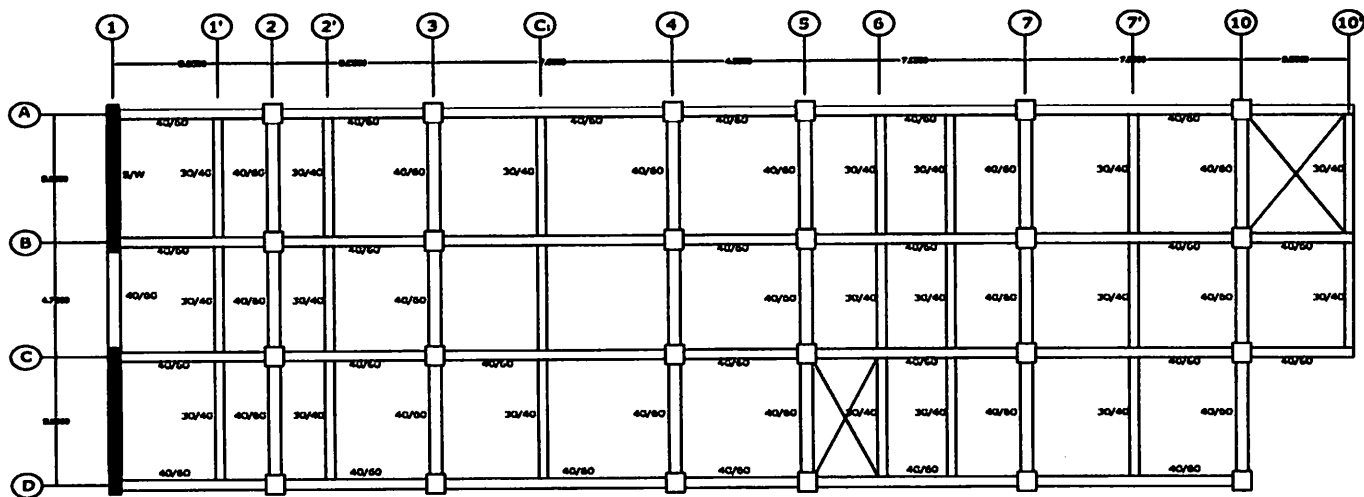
Denah Pembalok Lantai 9 - 12
